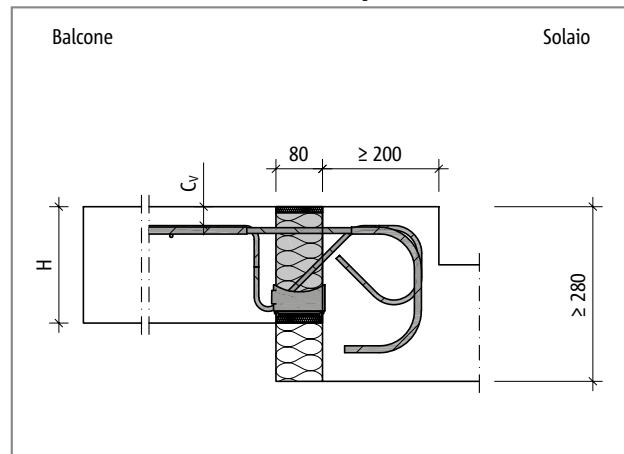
Schöck Isokorb® T tipo KL-O-M8 – KL-O-M12: balcone con innalzamento e isolamento esterno
